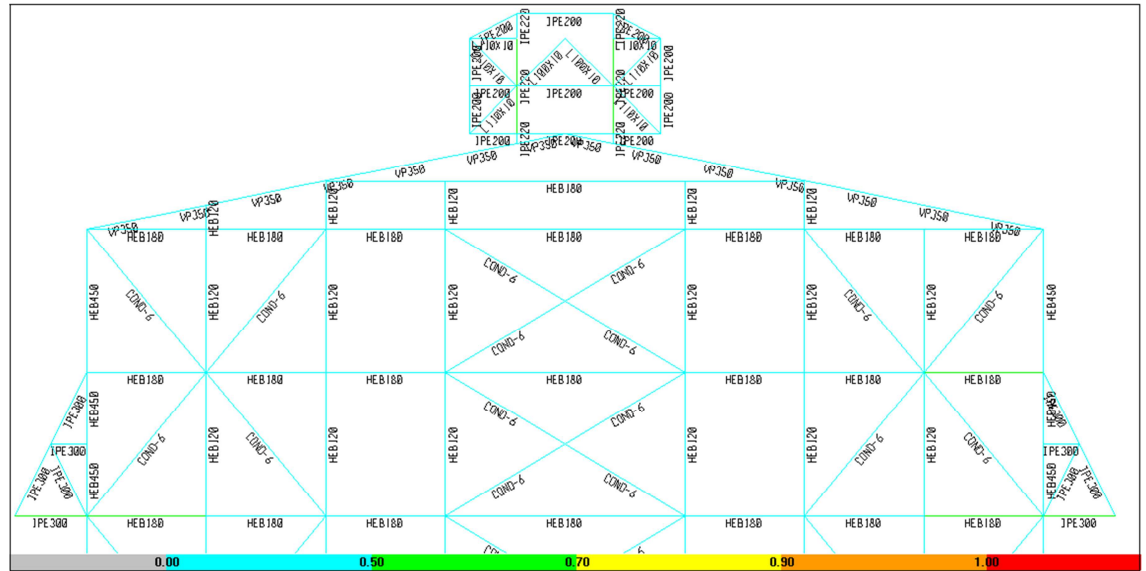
Chequeo del Robertson bajo las combinatorias de carga, vista frontal.
